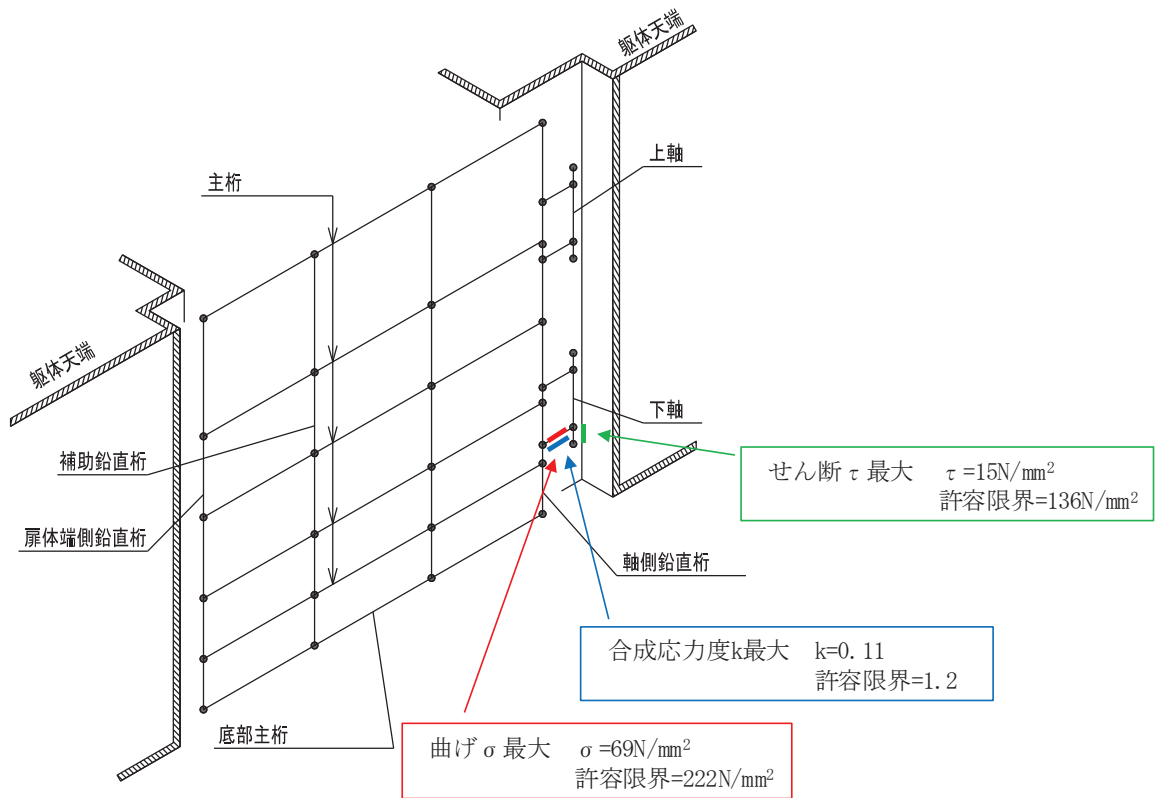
ヒンジの曲げ・軸力系の破壊及びせん断破壊に対する
